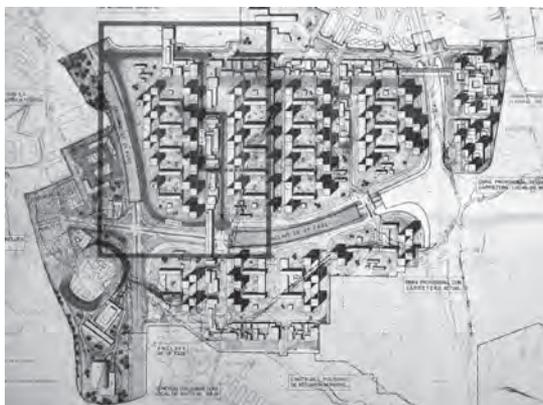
Plano de ordenación, plano de volúmenes y maquetas del Plan Sur, 1968
